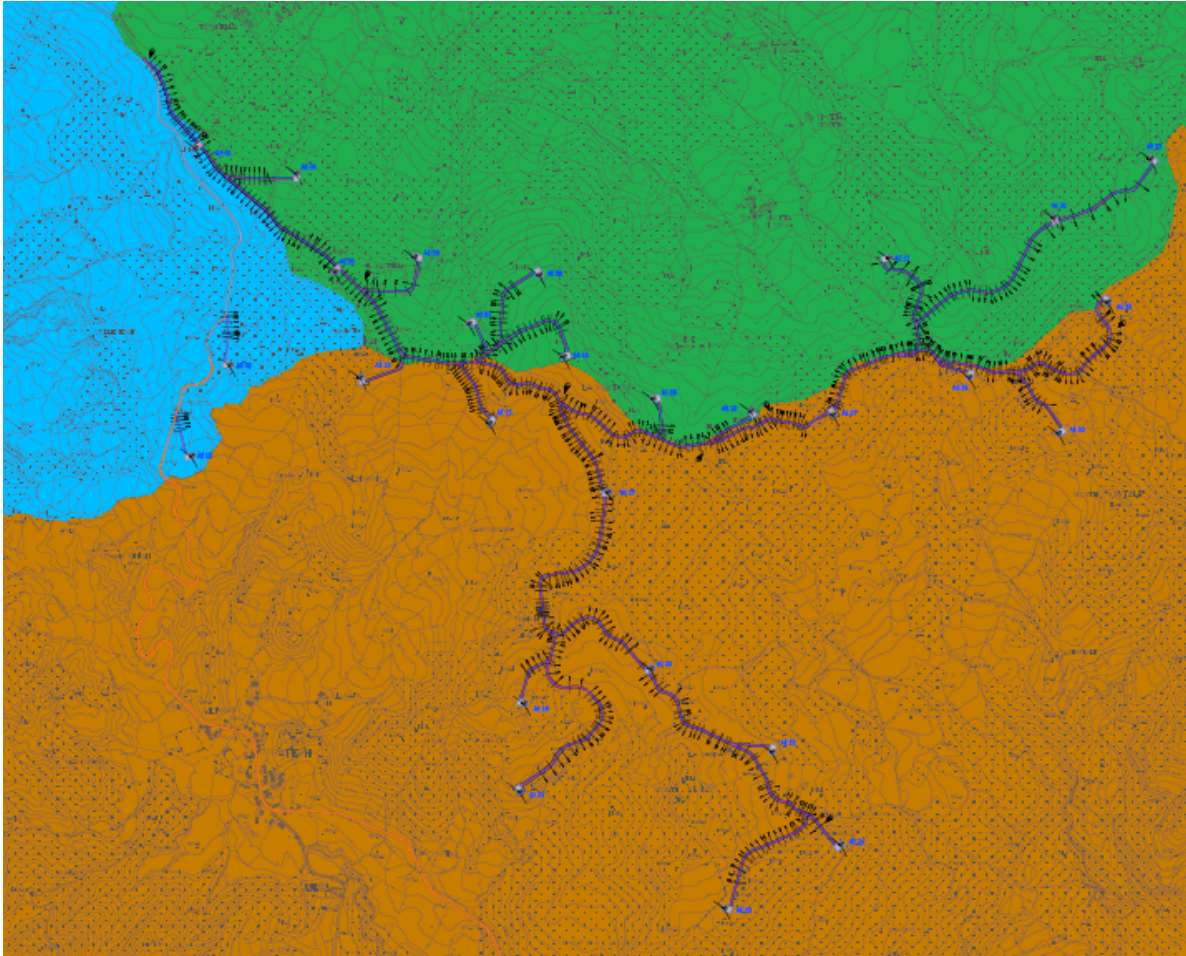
Schema planimetrico nuova Ipotesi 2
